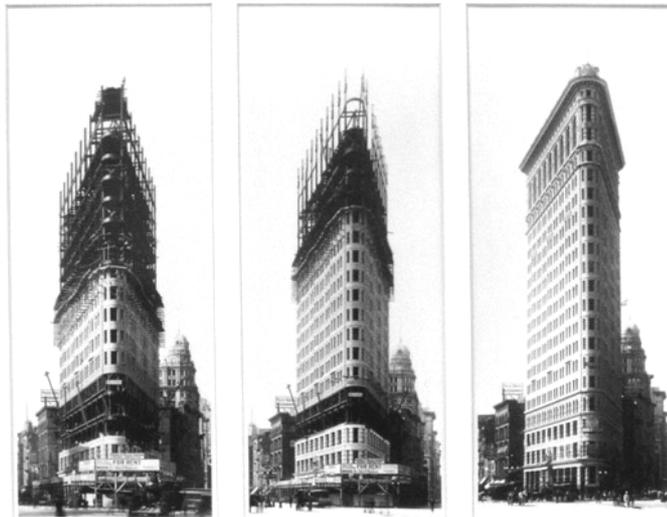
Estructura metálica y proceso de construcción y revestimiento en piedra del Flatiron Building, New York, 1902, Daniel Hudson Burnham.
